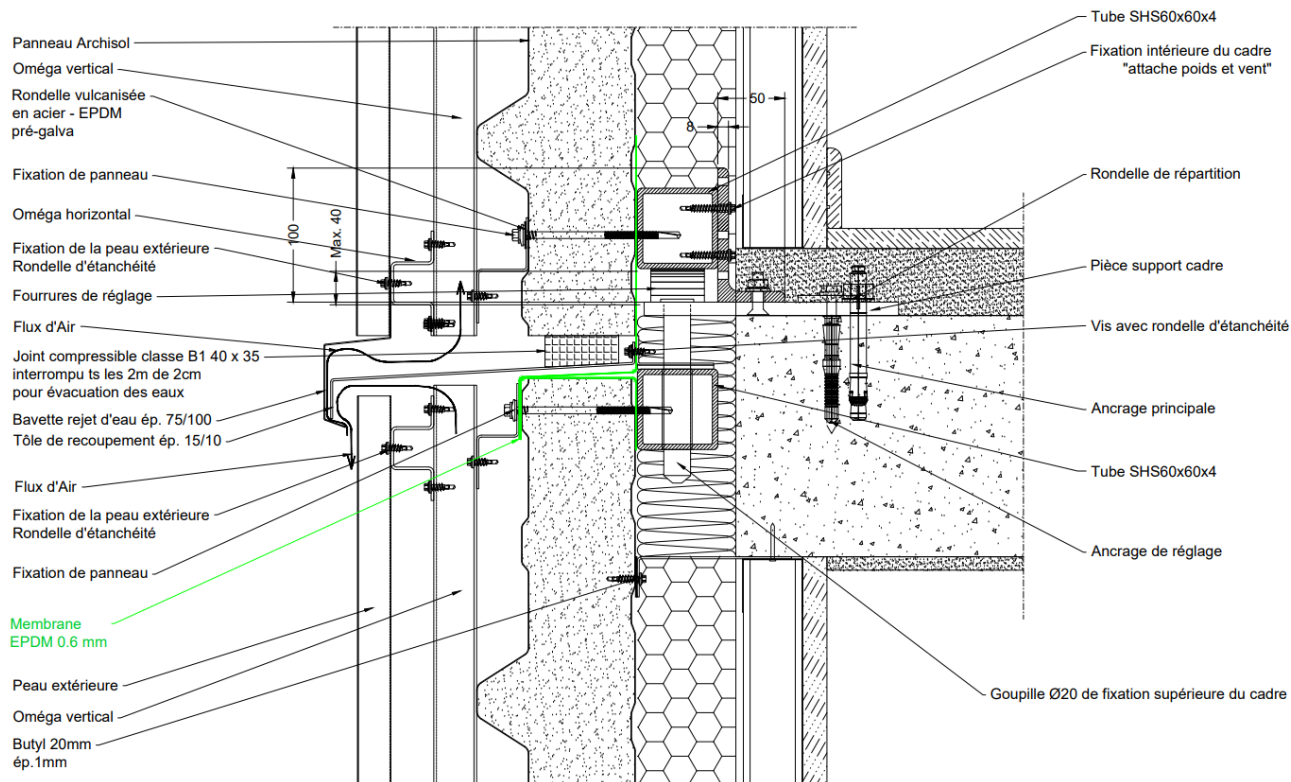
Coupe verticale sur la jonction horizontale entre modules D2B Archisol – Ancrage de rive (poids et vent) - Ossature en double réseau.
